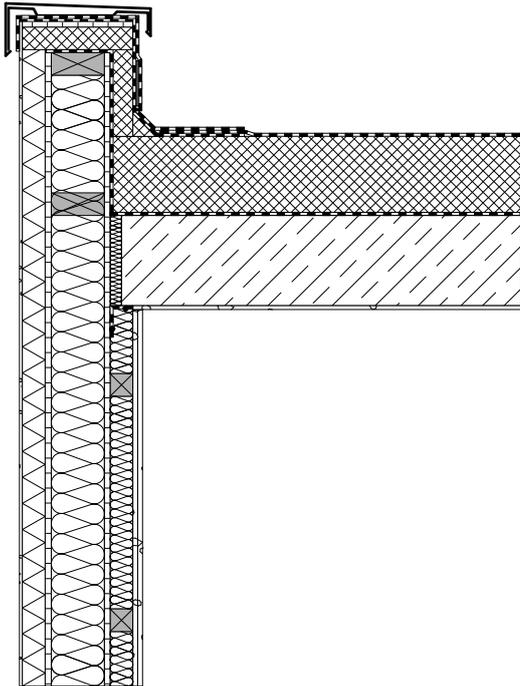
Anschluss Flachdach DA1 - Außenwand WA1-3 mit Attika
